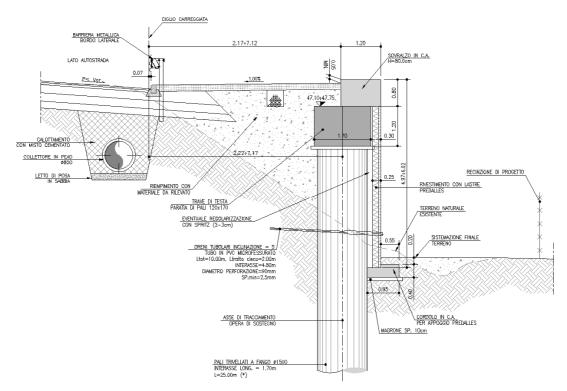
Sezione tipo opera di sostegno MS022 – Tratto 1
